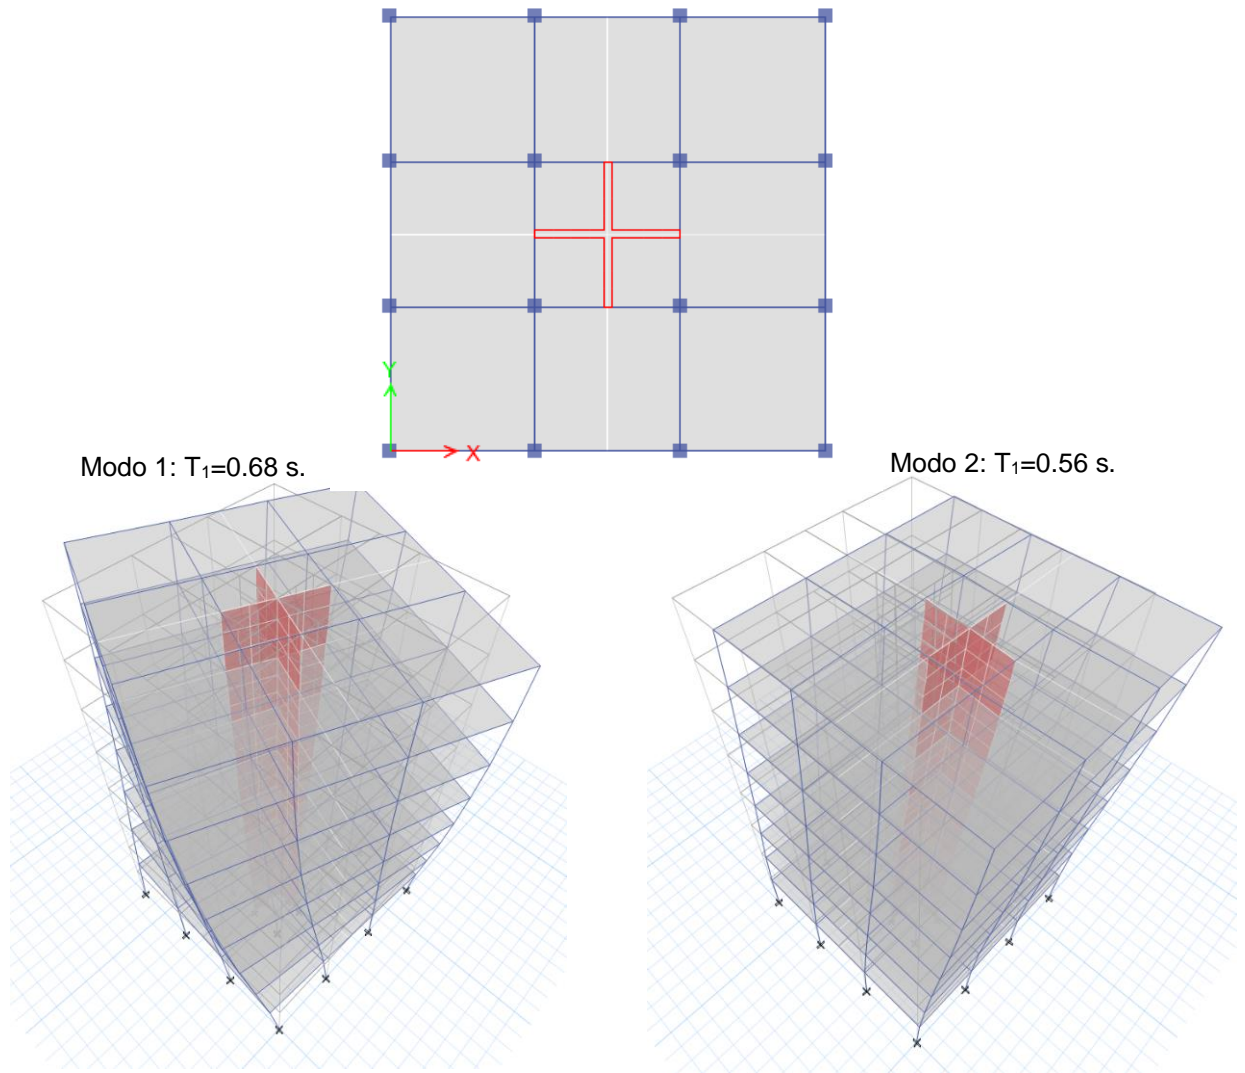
Ejemplo: planta estructural y modos de vibración de un edificio regular y simétrico.
